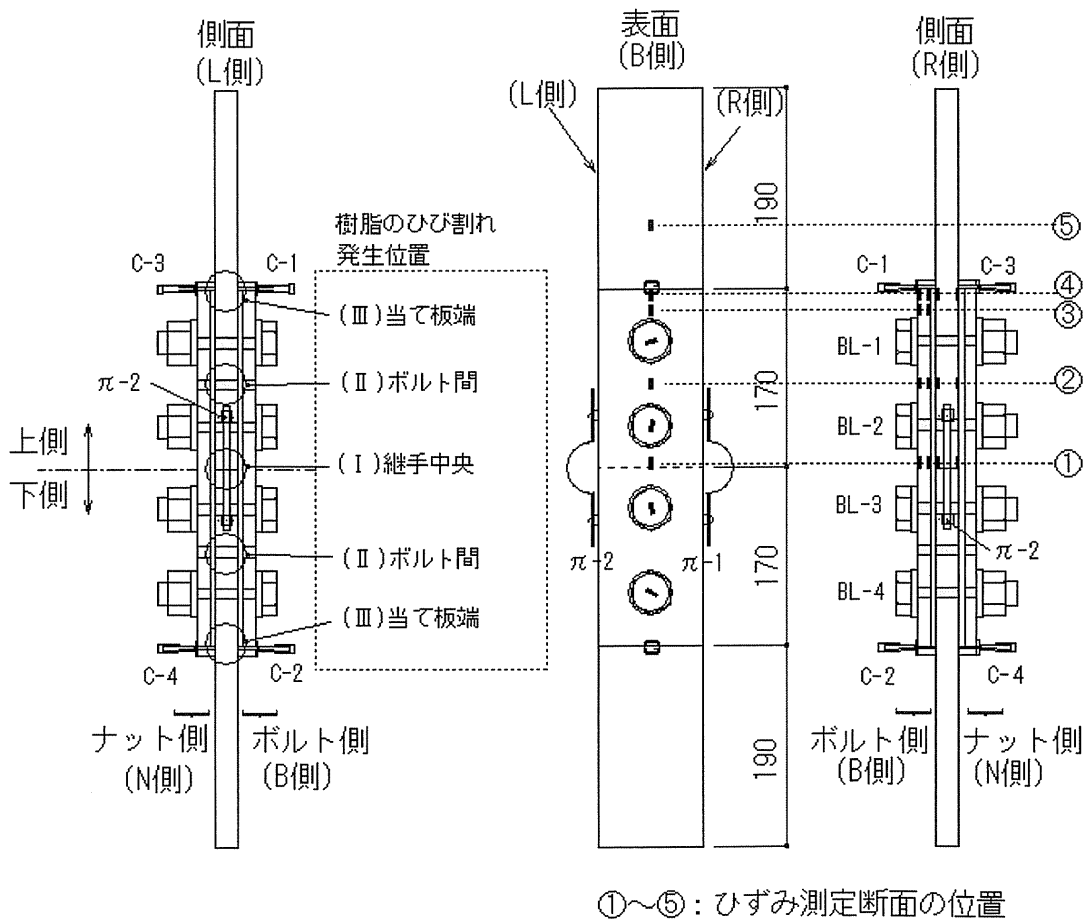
载荷に伴う樹脂のひび割れ発生位置
